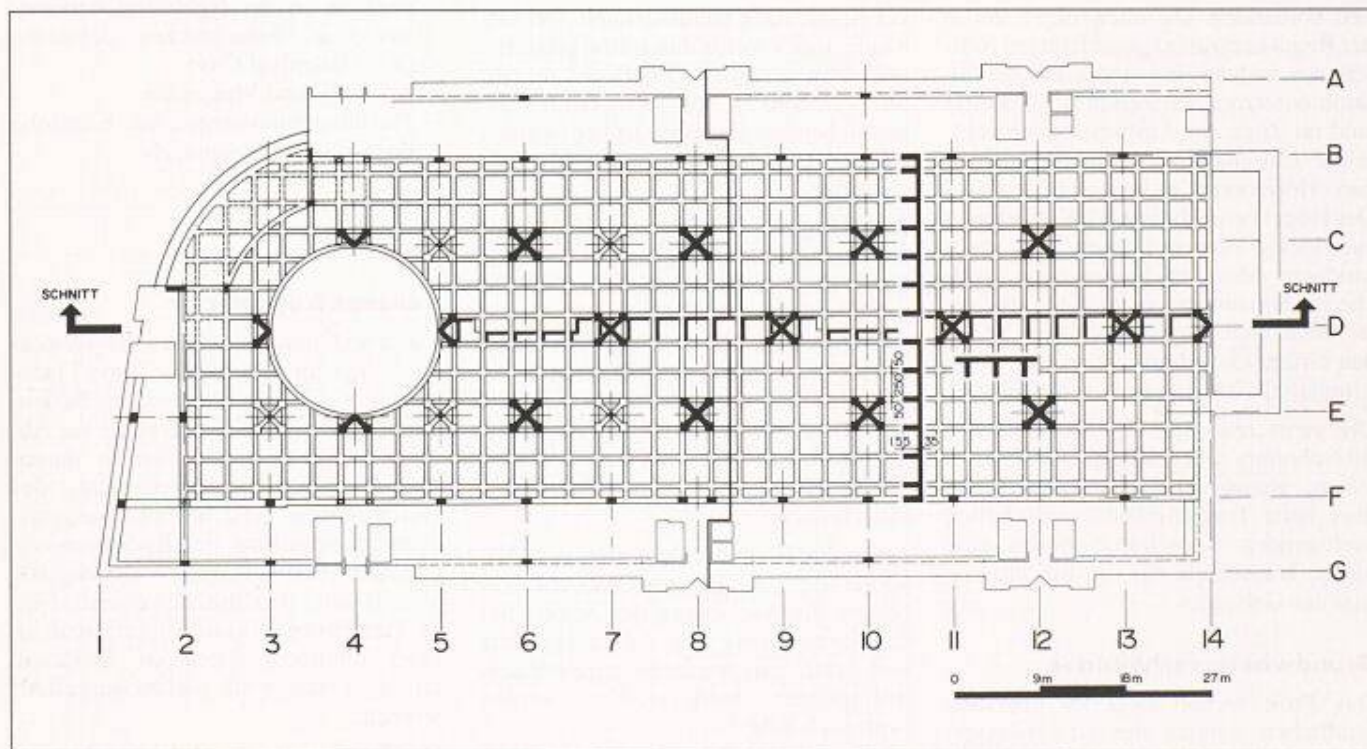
Grundriss Kassettendecke (Legende: Schwarzflächen = Auflager Kassettendecke)
